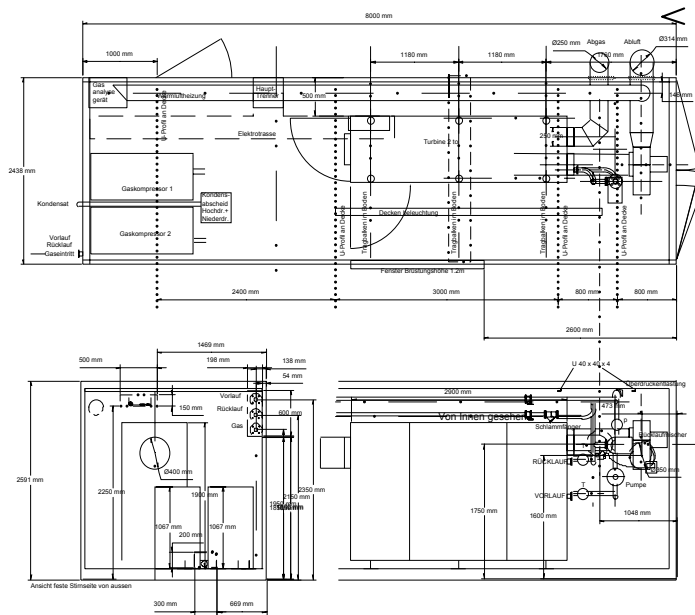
Grundriss und Schnitt durch den Maschinencontainer
